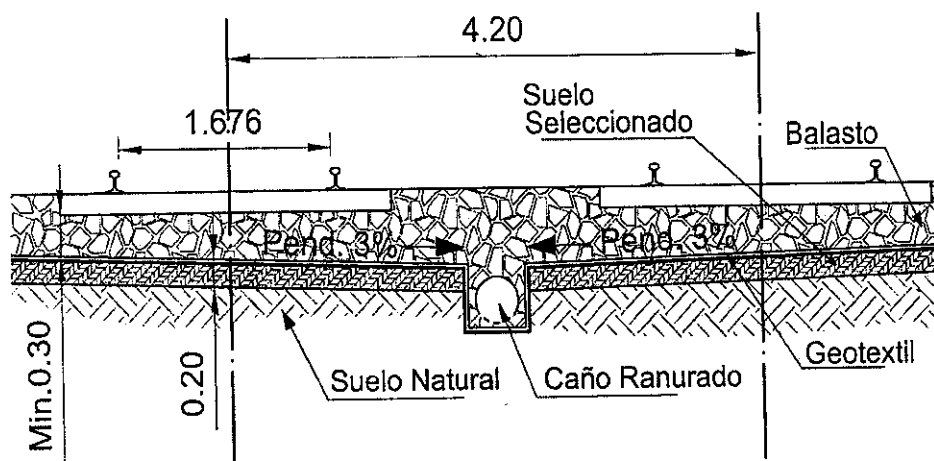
Corte transversal de vía doble con drenaje en entrevía.
